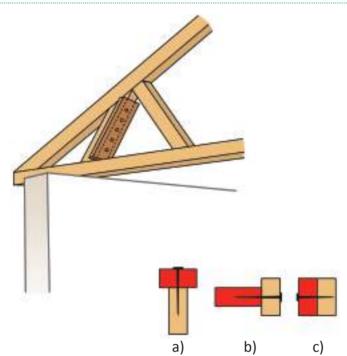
Antiflambement d'un groupe de jambettes d'appui
